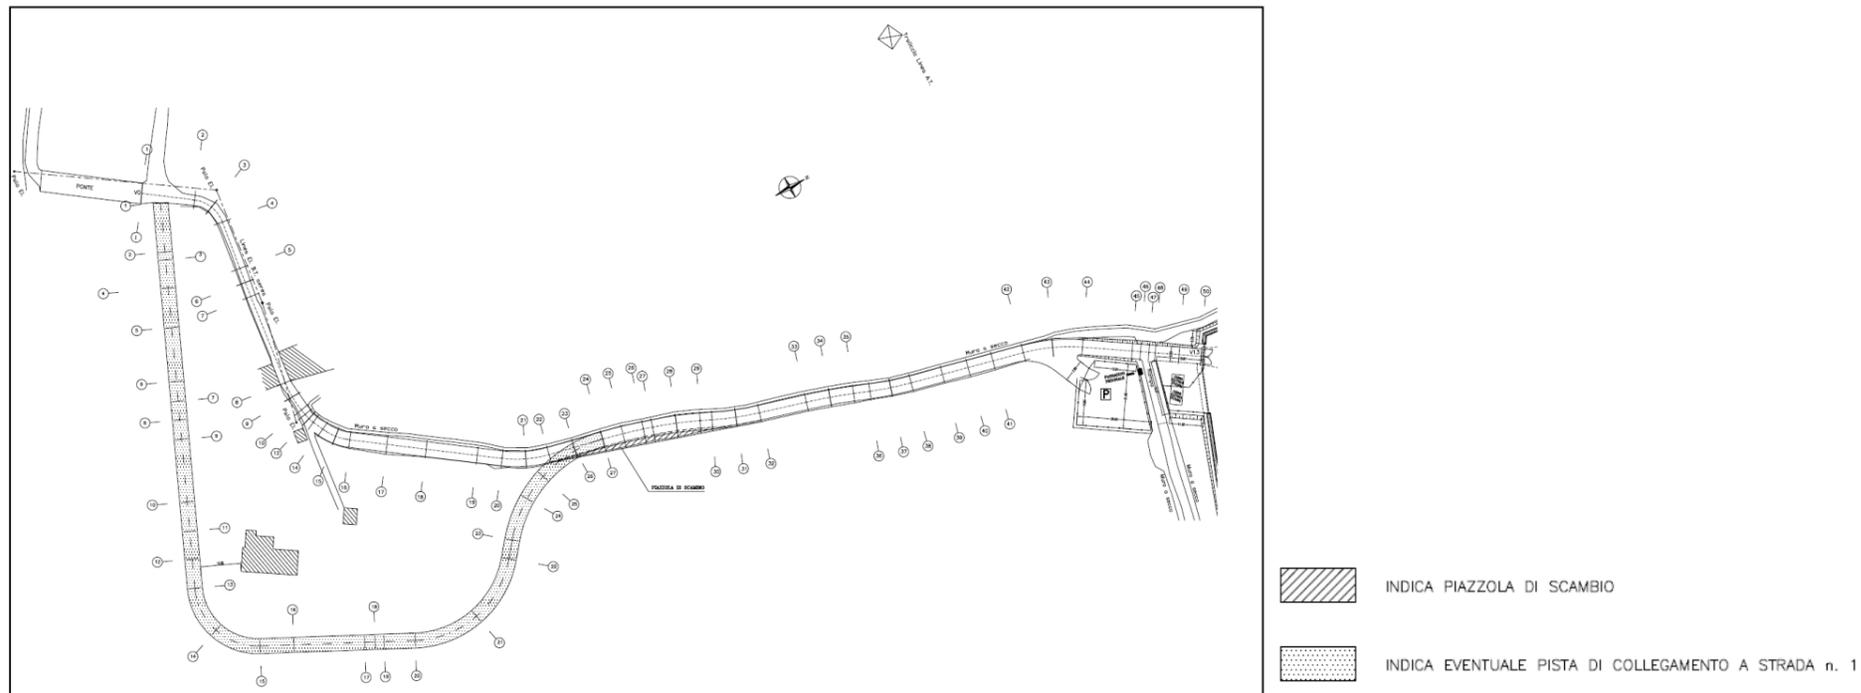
Strada di accesso 1 e pista di collegamento
